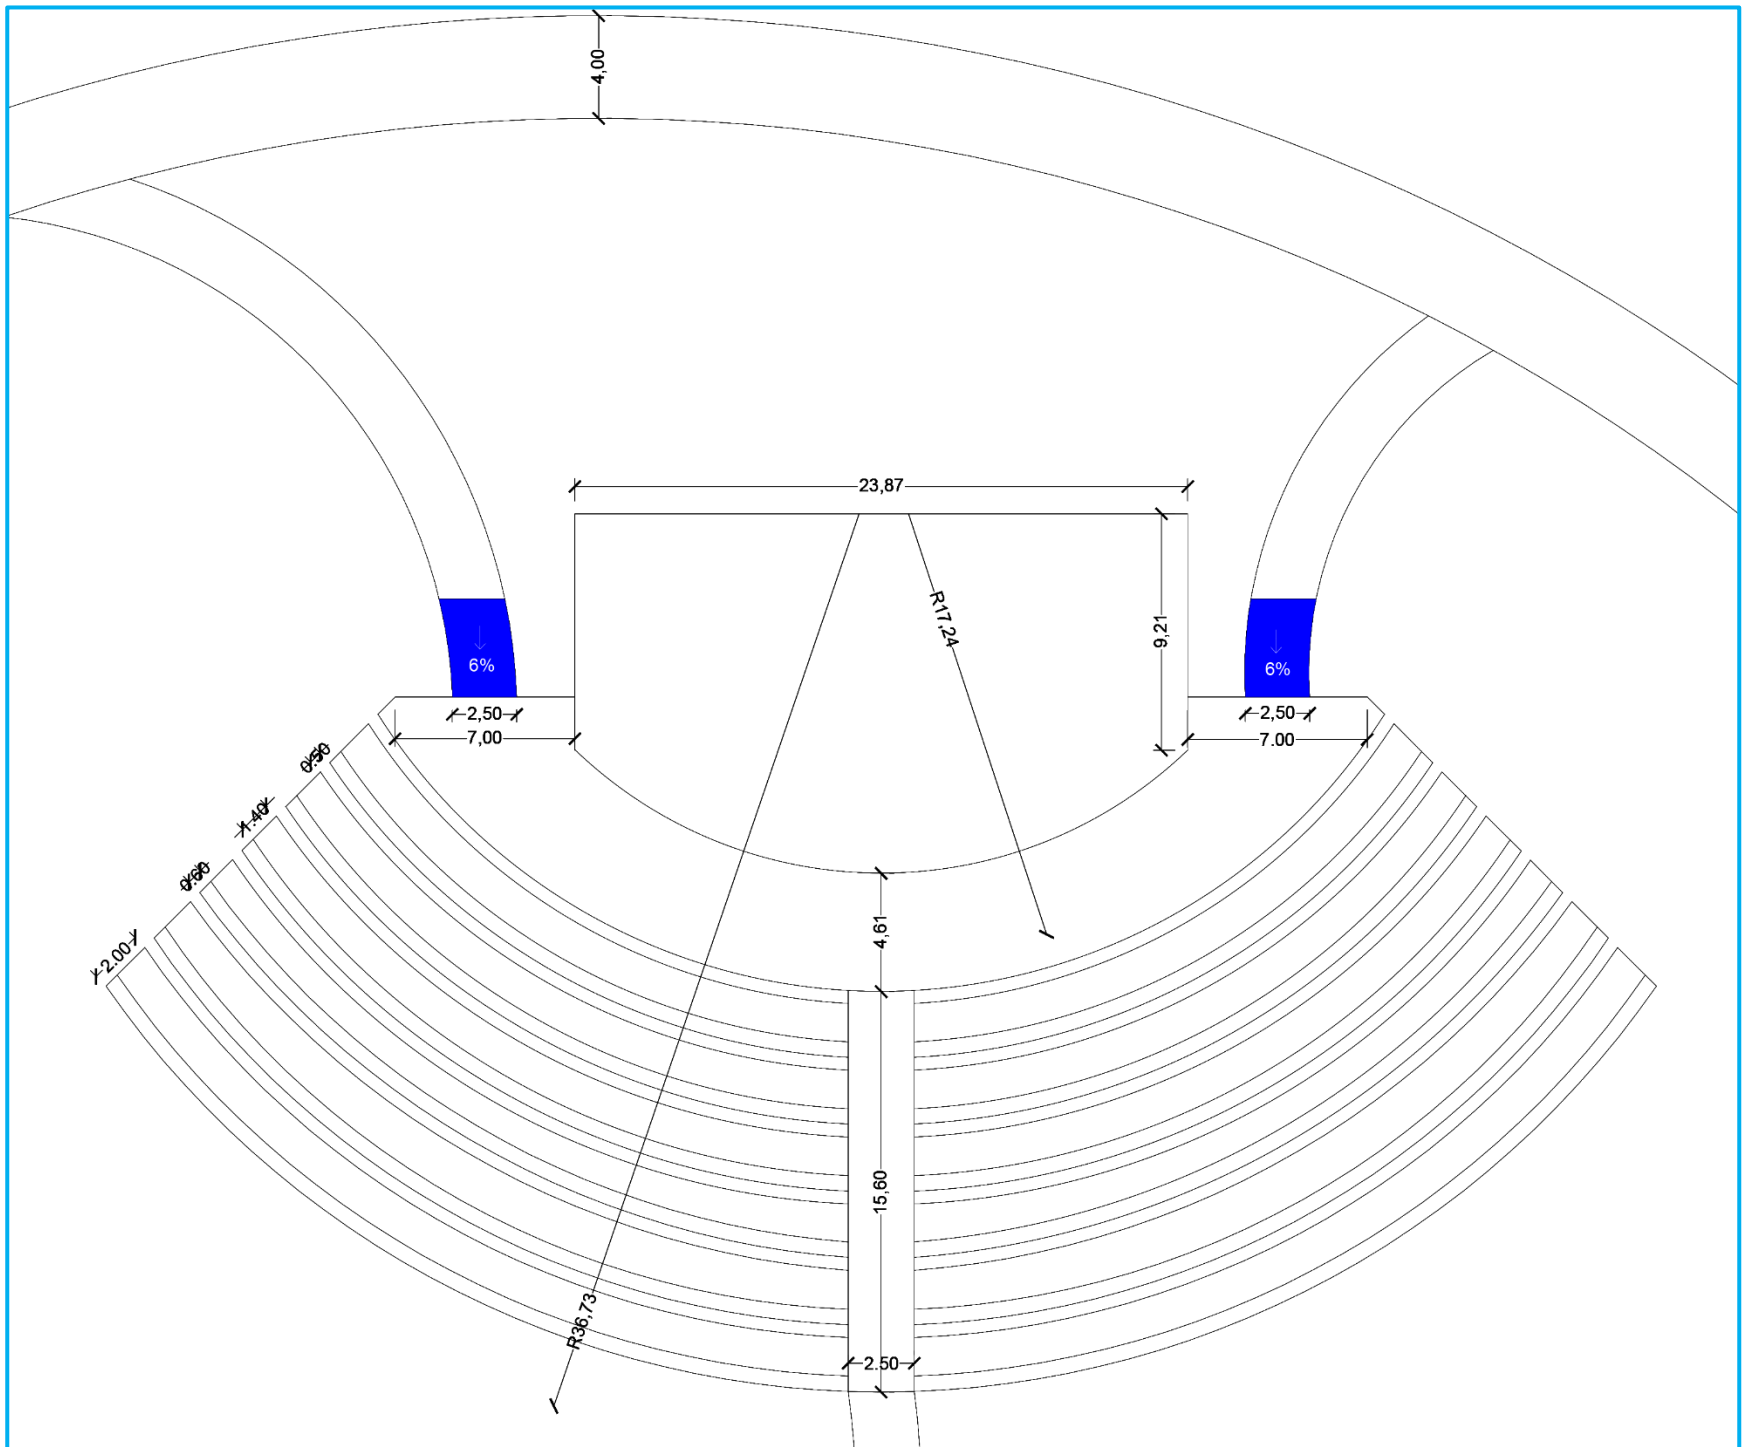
Detalle H. Plano técnico de anfiteatro. Elaboración propia. 2025. Escala 1:250
